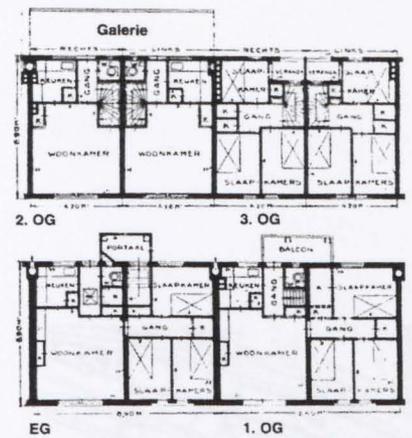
Grundrisse Maisonetten, Spangenberg Michiel Brinkman 1919
